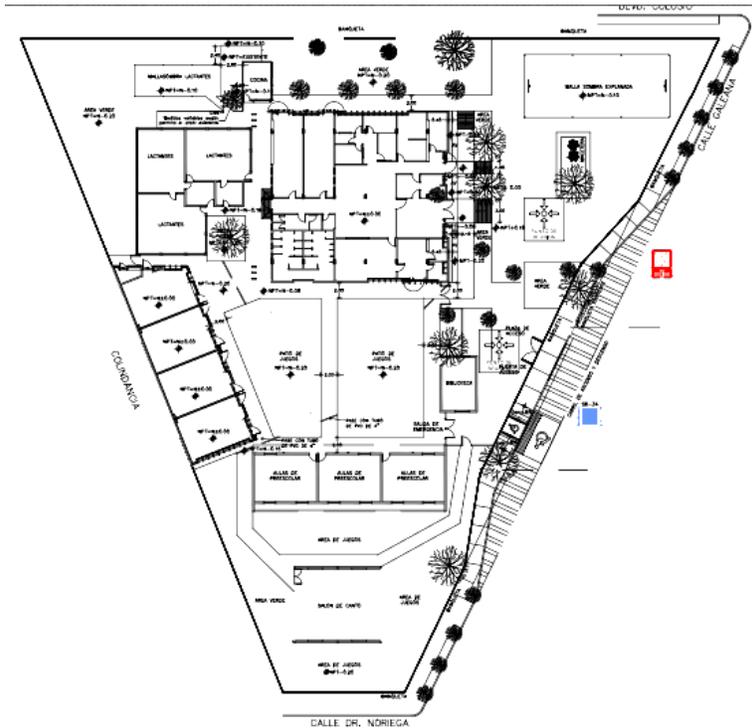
Planta Arquitectónica del Centro de Desarrollo Infantil.
